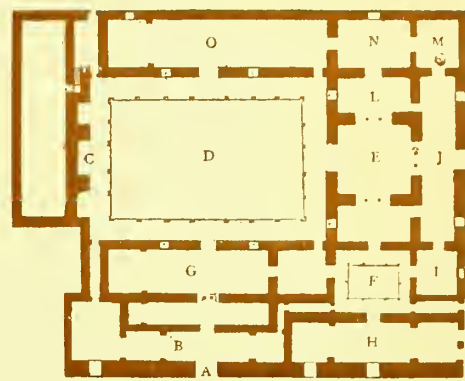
PLANTA DEL ALCÁZAR DE SEVILLA, SEGÚN D. RAFAEL CONTRERAS
